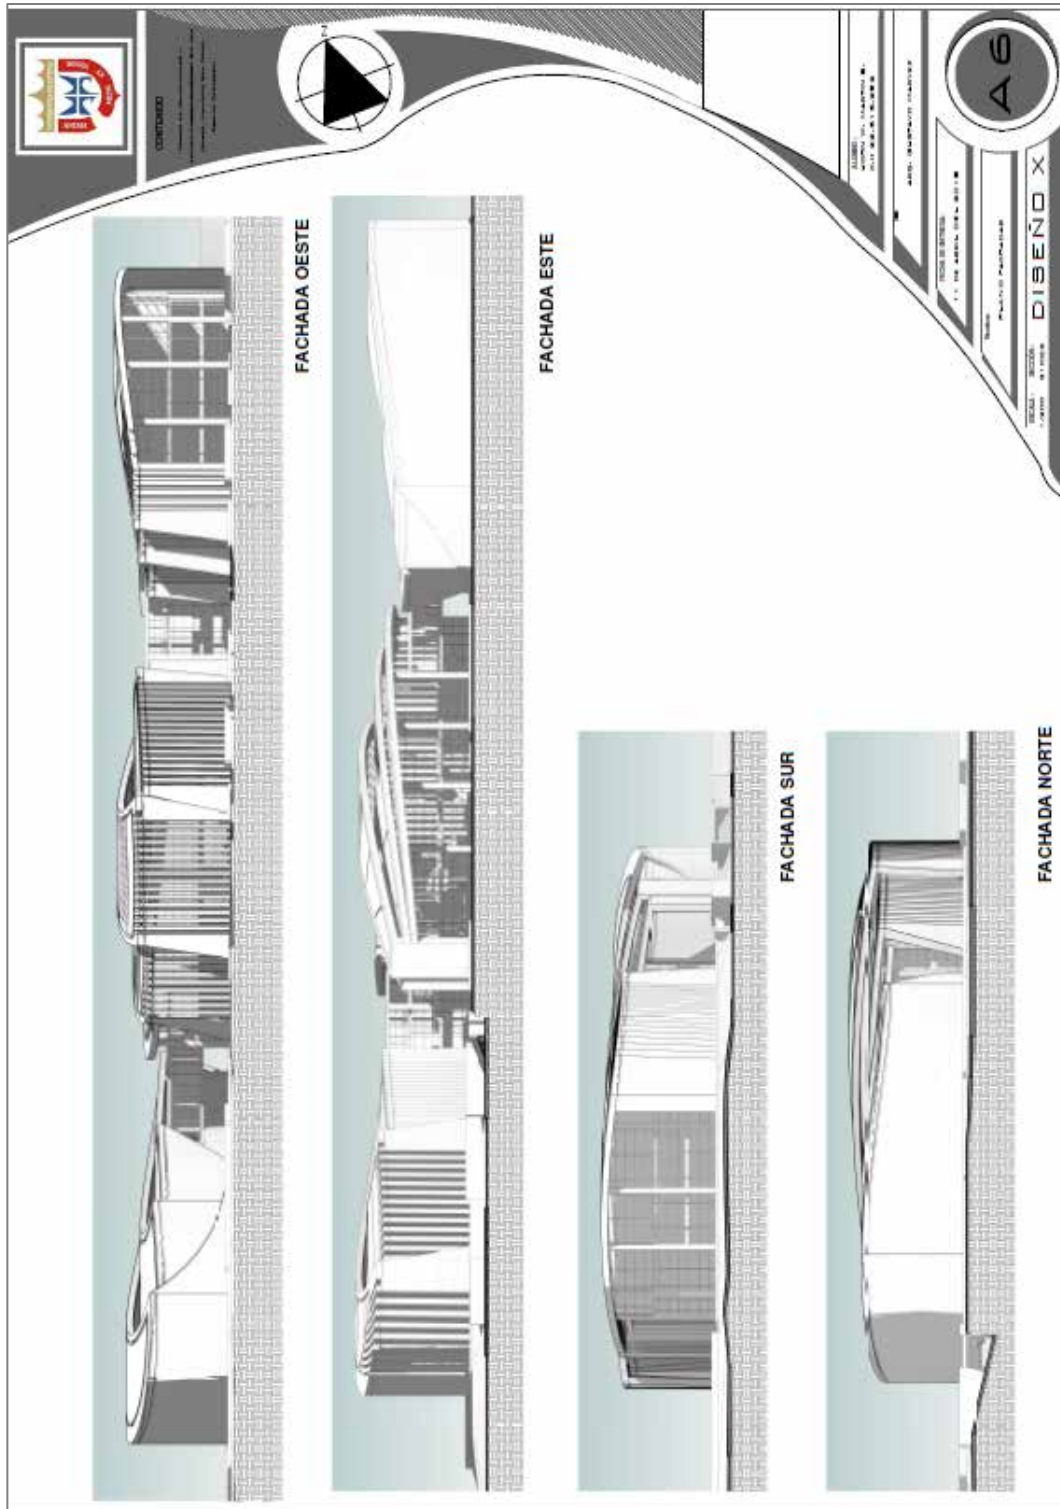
Fachadas Norte, Sur, Este y Oeste (2018)
